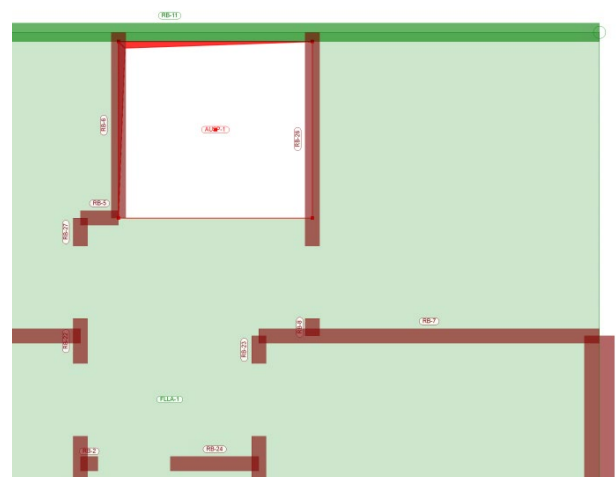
Wandachsen auf Platten- und Aussparungsrand
